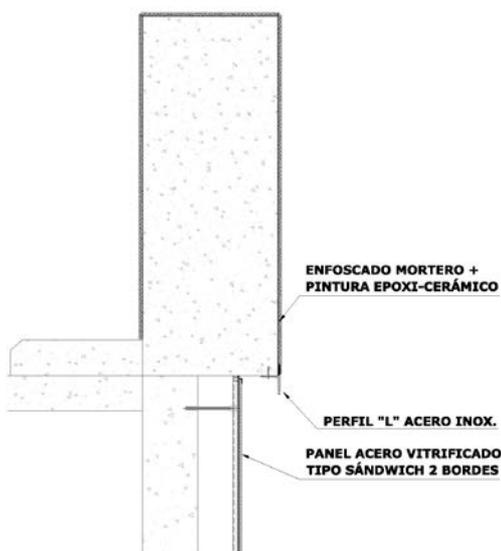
Detalle de remate de arista con perfil “L” de acero inoxidable
